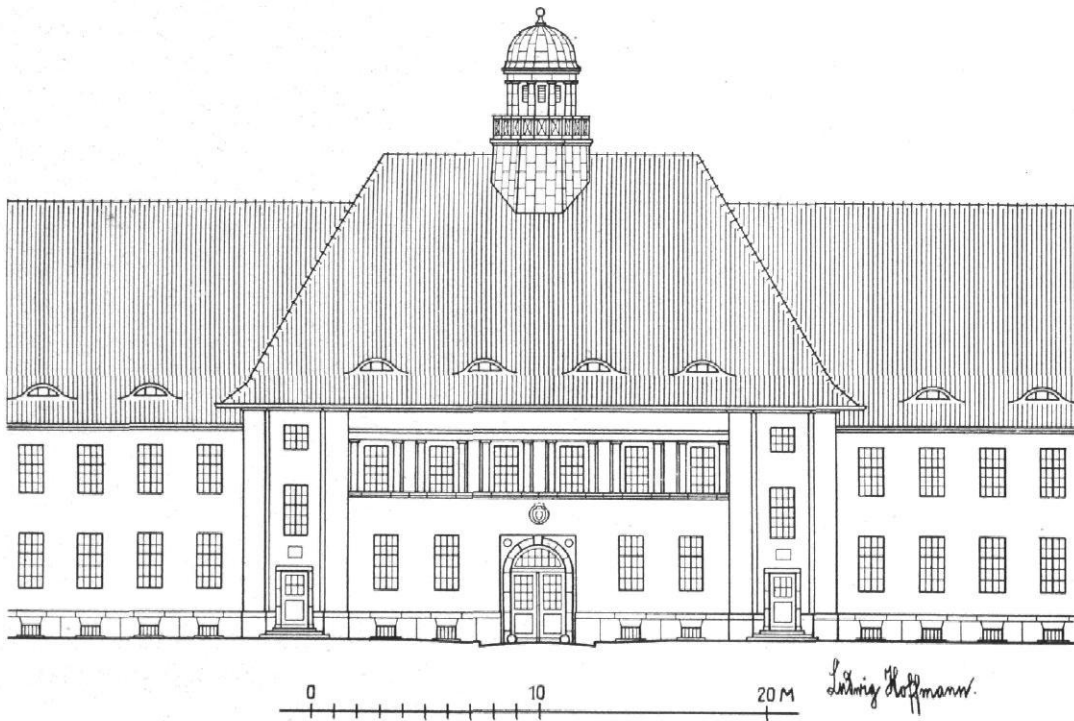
u. 14. Verwaltungsgebäude. Rückfassade
